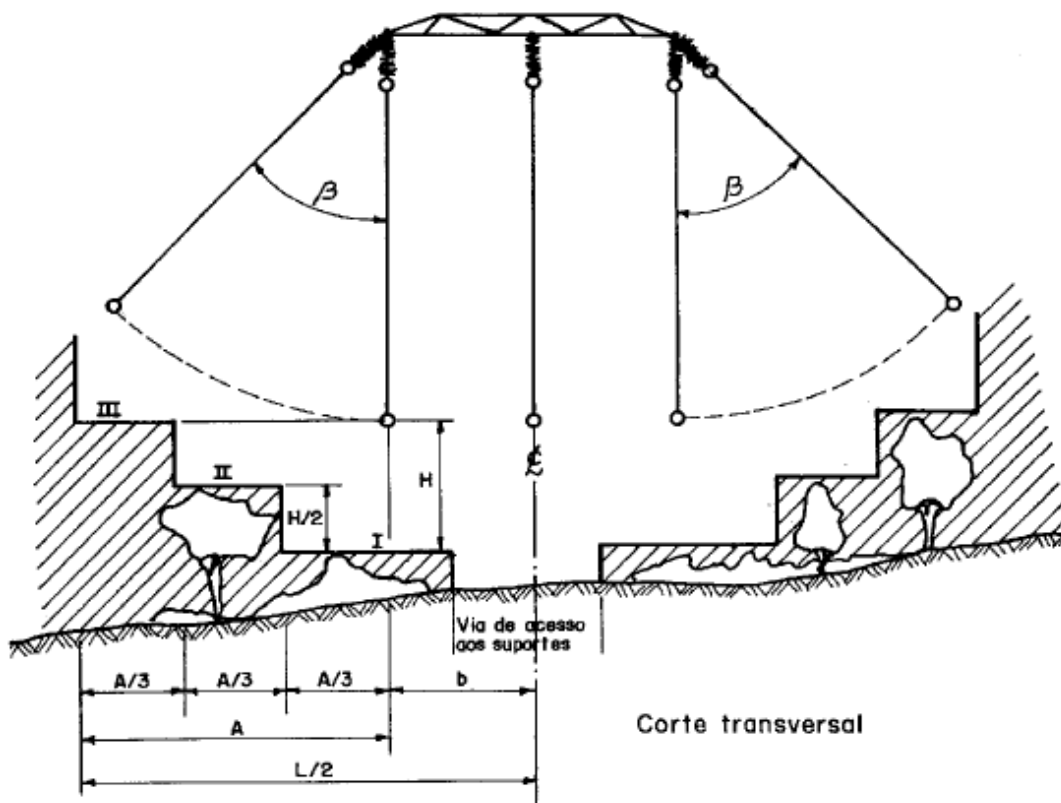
Corte Seletivo – Seção Transversal
